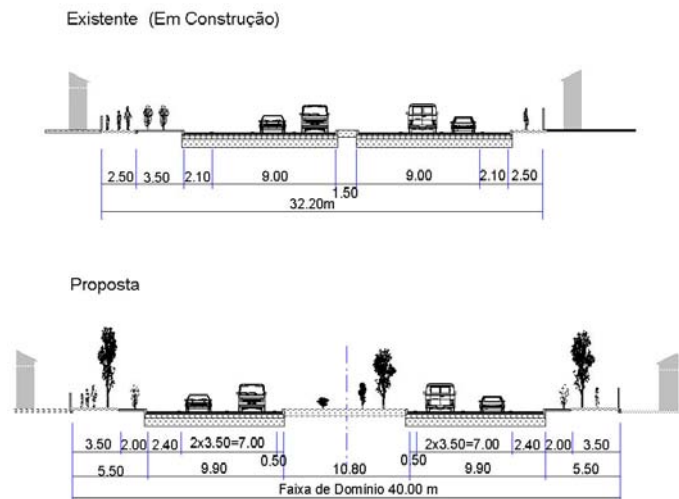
Seção Transversal Proposta para a Avenida Primeiro de Dezembro
